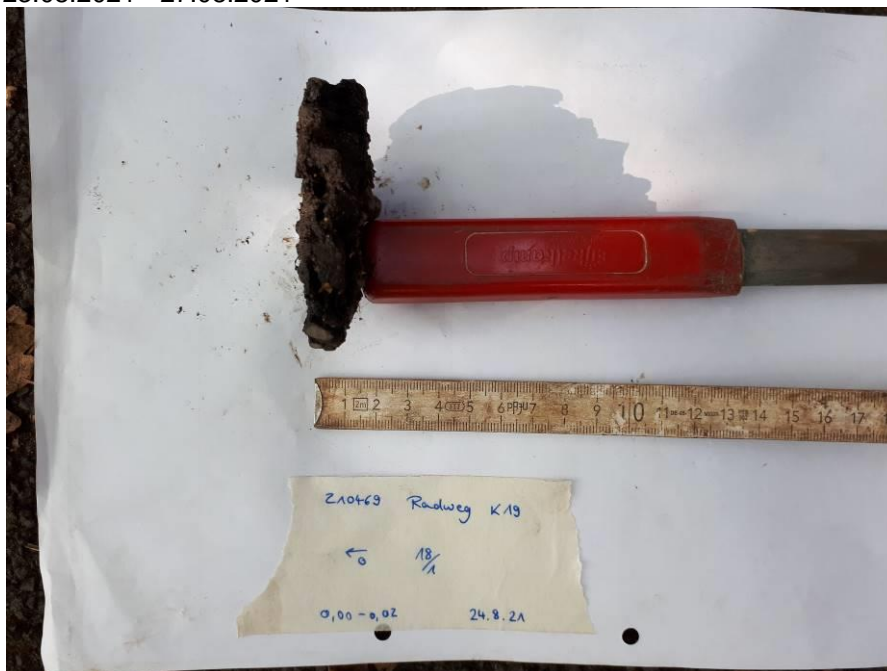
Detailfoto Kern 18/1 (0,00-0,02 m)
